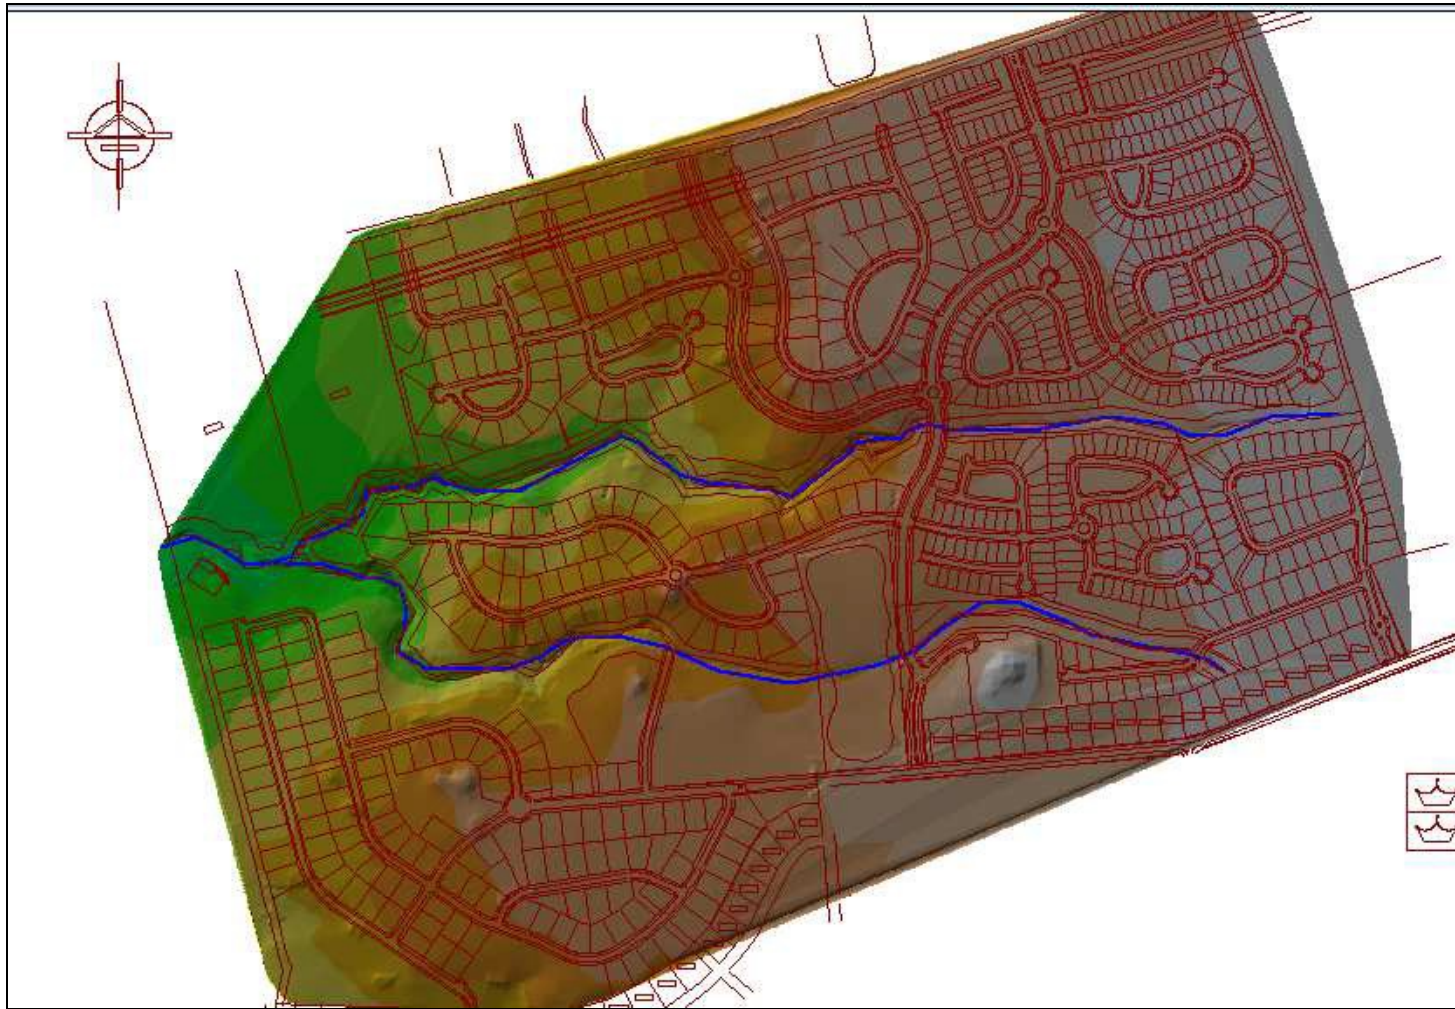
13 Distribución en planta en relación con los cauces de las dos quebradas existentes del proyecto Condominio Los Reyes.
